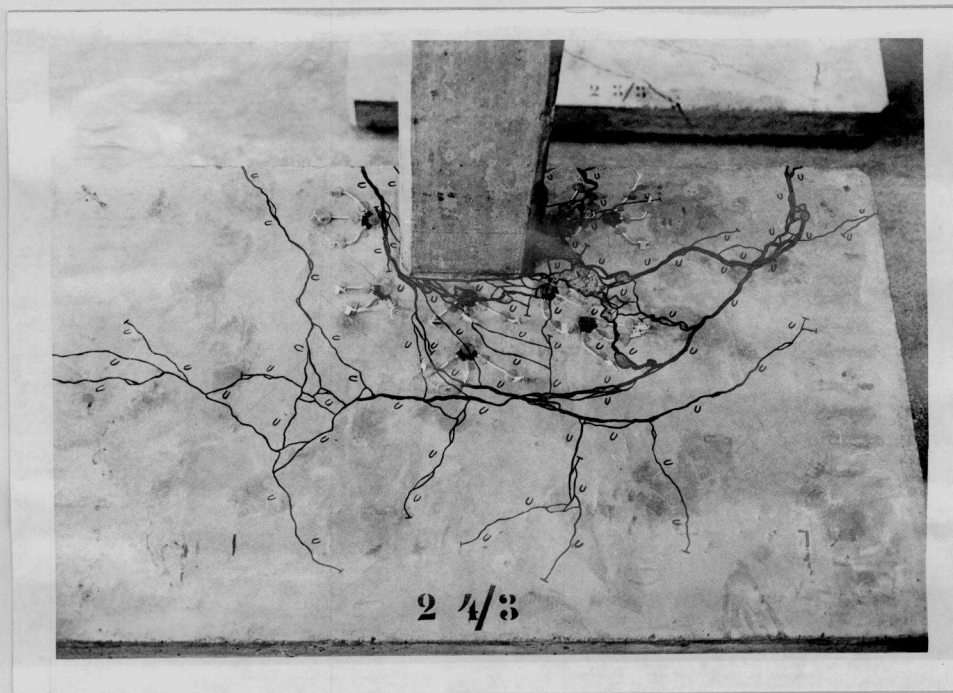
c - Fissuração na face inferior do modelo EdL 24/3.
